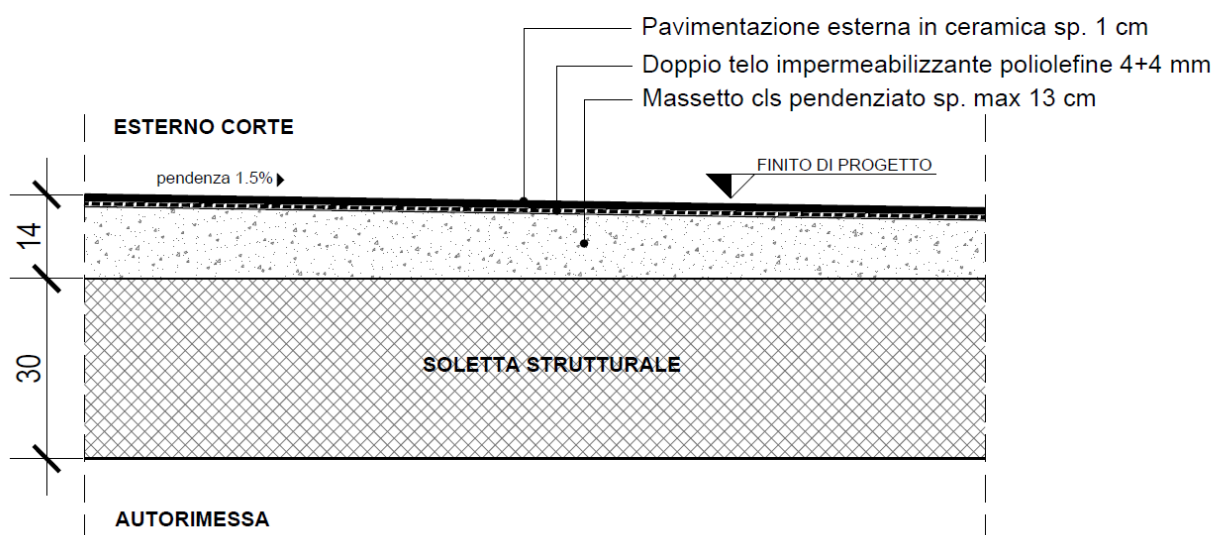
dettaglio della porzione di solaio della terrazza impianti previsto sopra l'autorimessa
